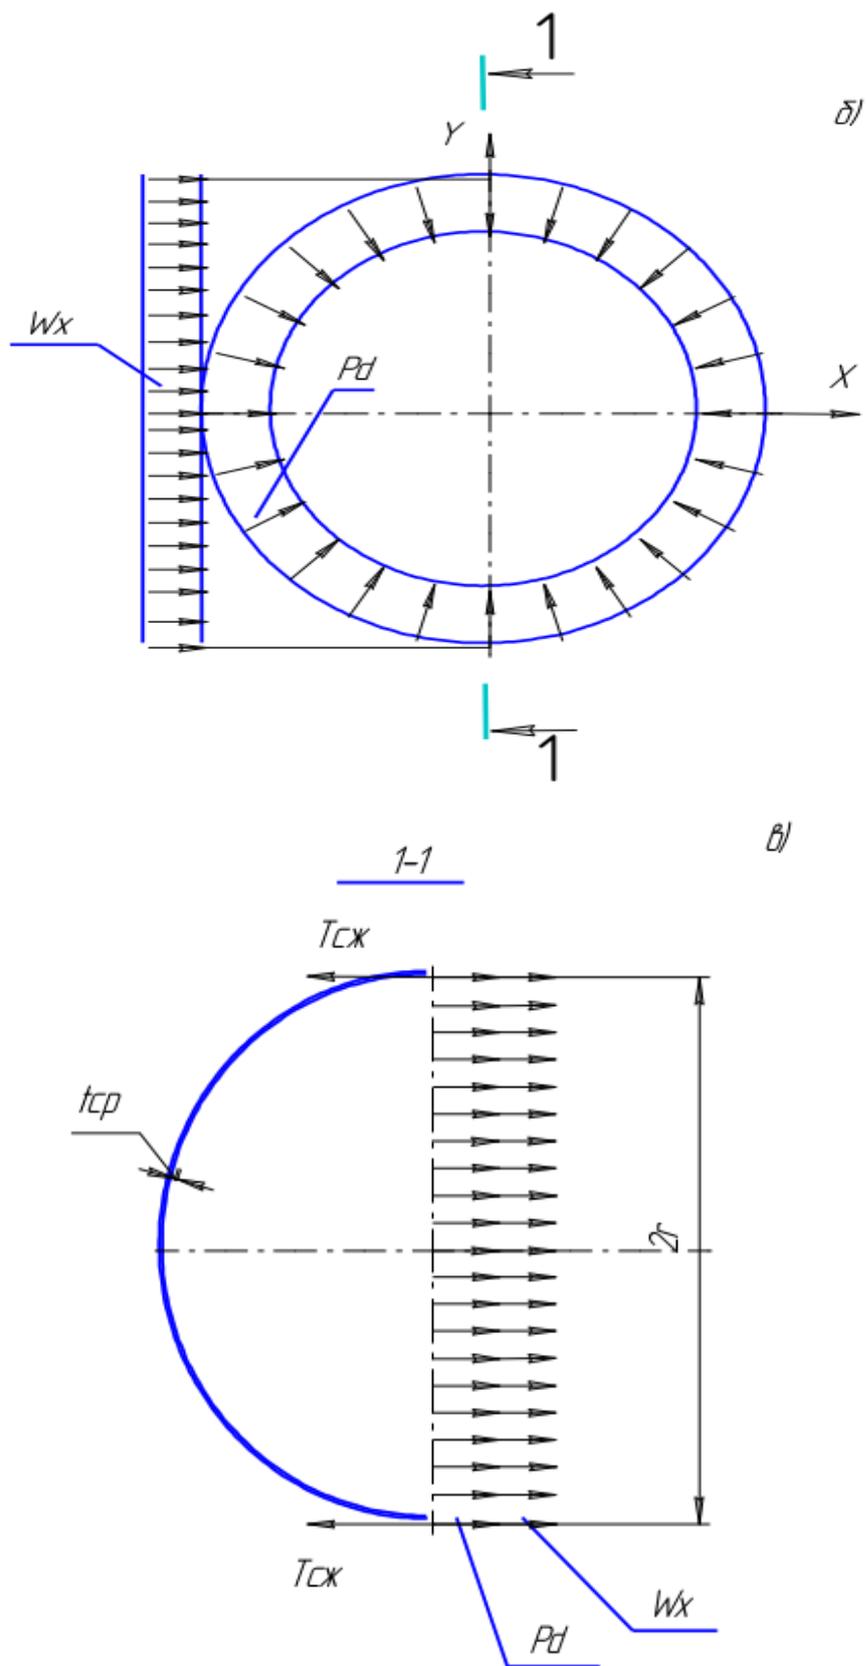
Расчет устойчивости стенки от кольцевых нагрузок и воздействий: а)-схема нагружения; б)-расчетная схема
